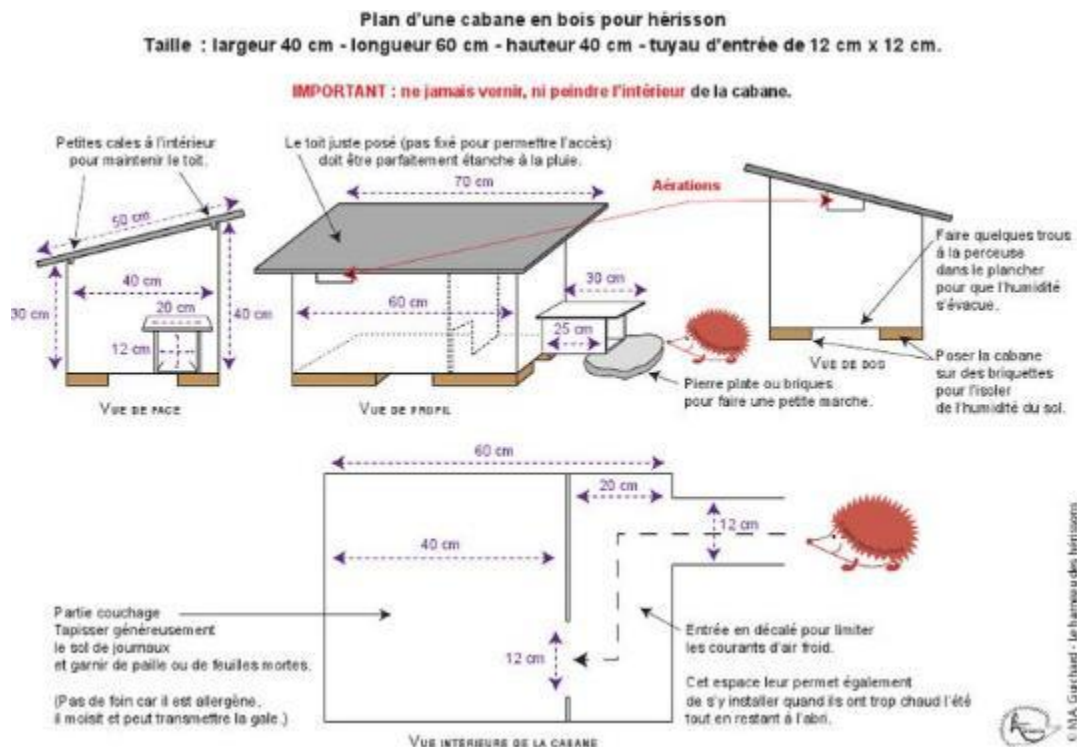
Exemple d'un plan d'une cabane à hérisson.
